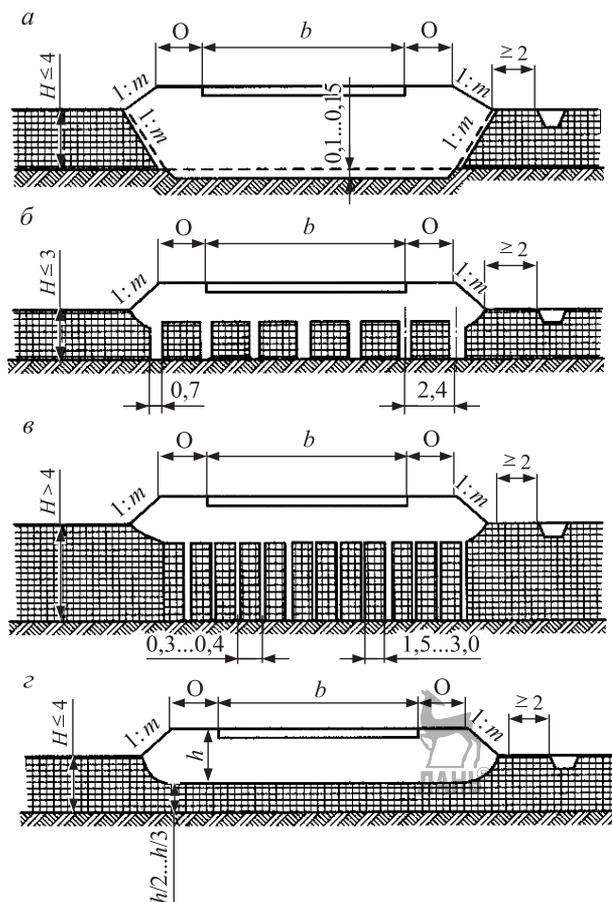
Конструкции поперечных профилей земляного полотна на болоте:
